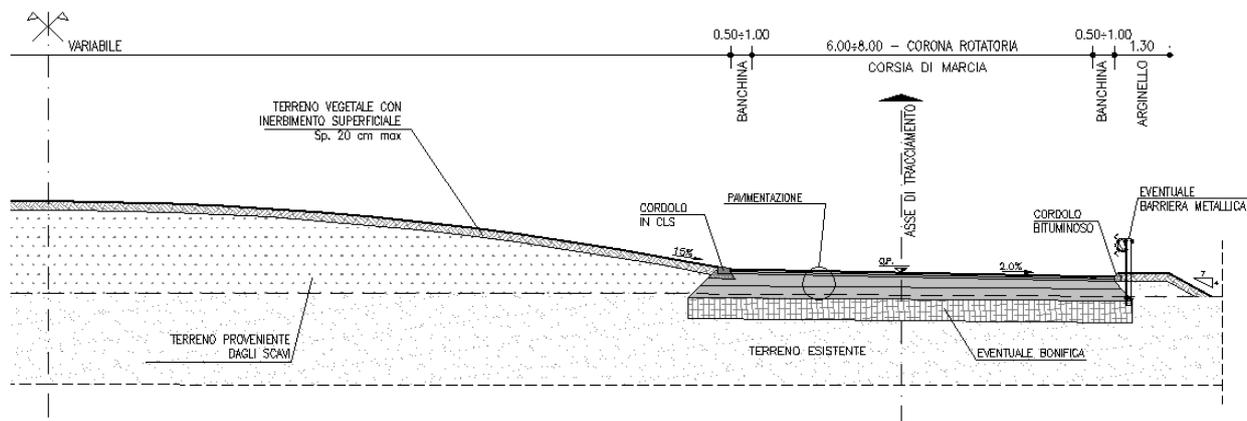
Sezione tipo di progetto della rotatoria con ingressi ad una corsia
